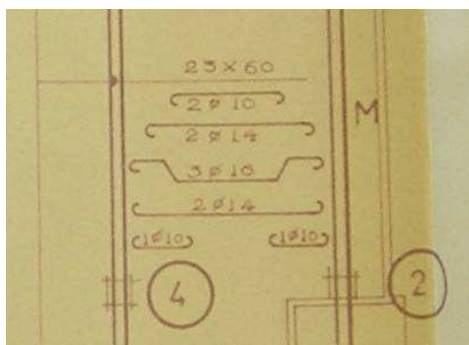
Detalle de despiece de armado de vigas. Edificio 118C.00
